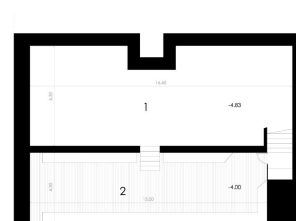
Planta -2, sótano. Fuente: ver cita 17
